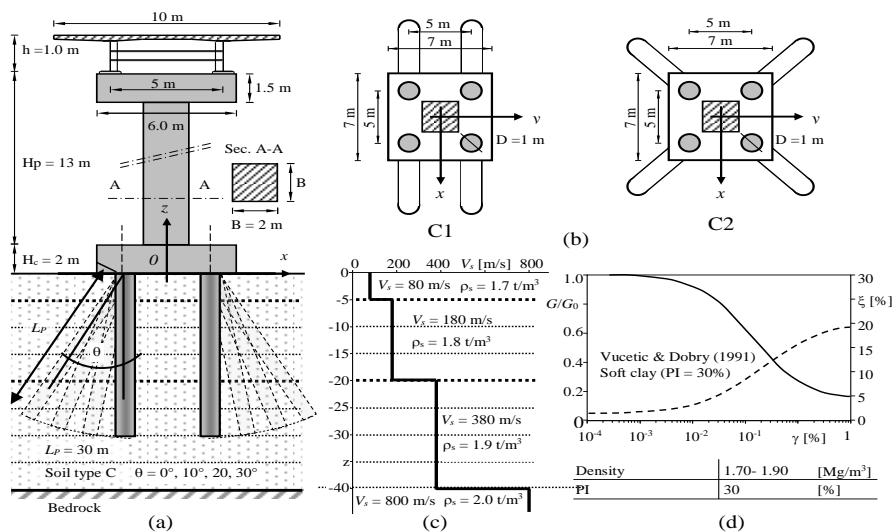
(a) Sezione trasversale del sistema sovrastruttura-fondazione-terreno; (b) Geometria fondazioni; (c) velocità delle onde di taglio e profilo del deposito considerato e (d) curve di decadimento e smorzamento del terreno
